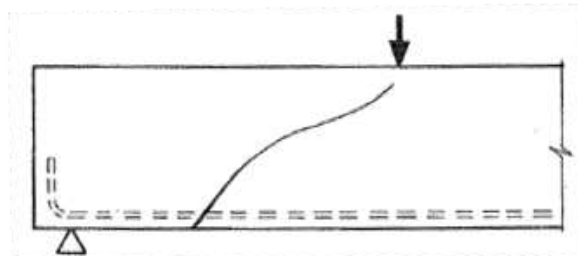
Esquema de la fisura Flexión-Cortante.
